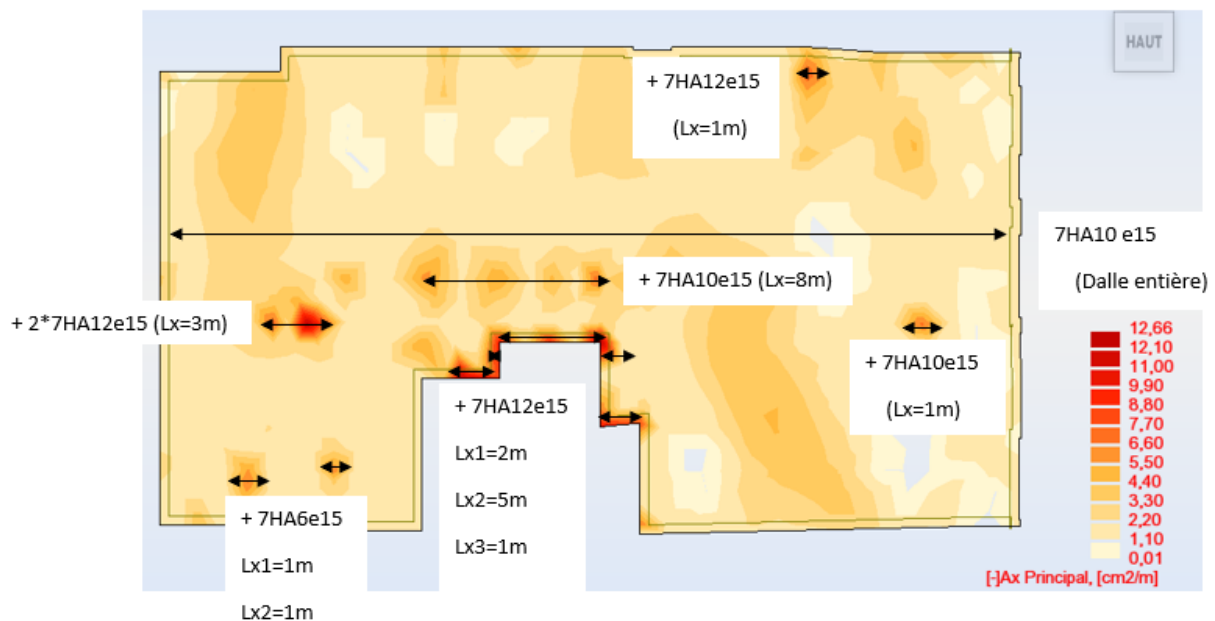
schéma de ferrailage du plancher haut 1er étage (lit inférieur d'armatures principales $A_x(-)$)
